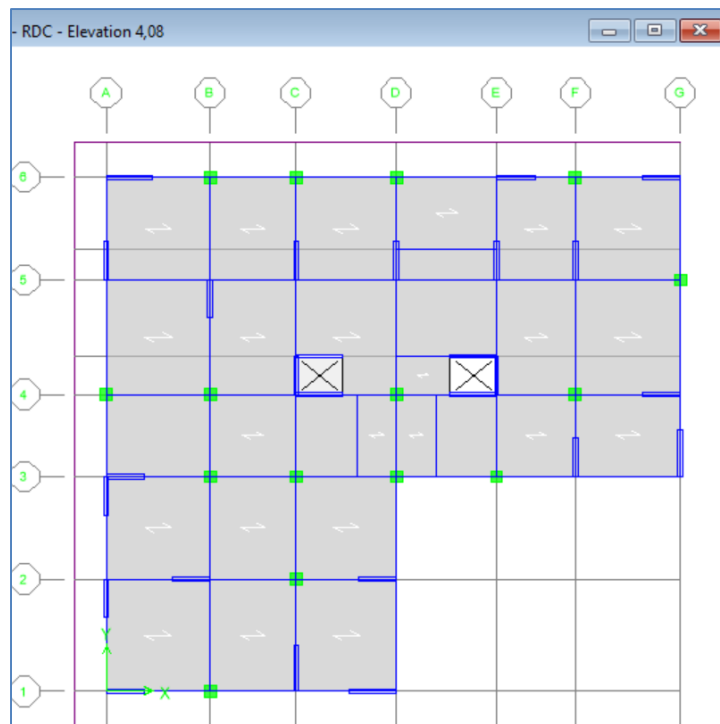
Vue en plan des éléments structuraux d'un étage
